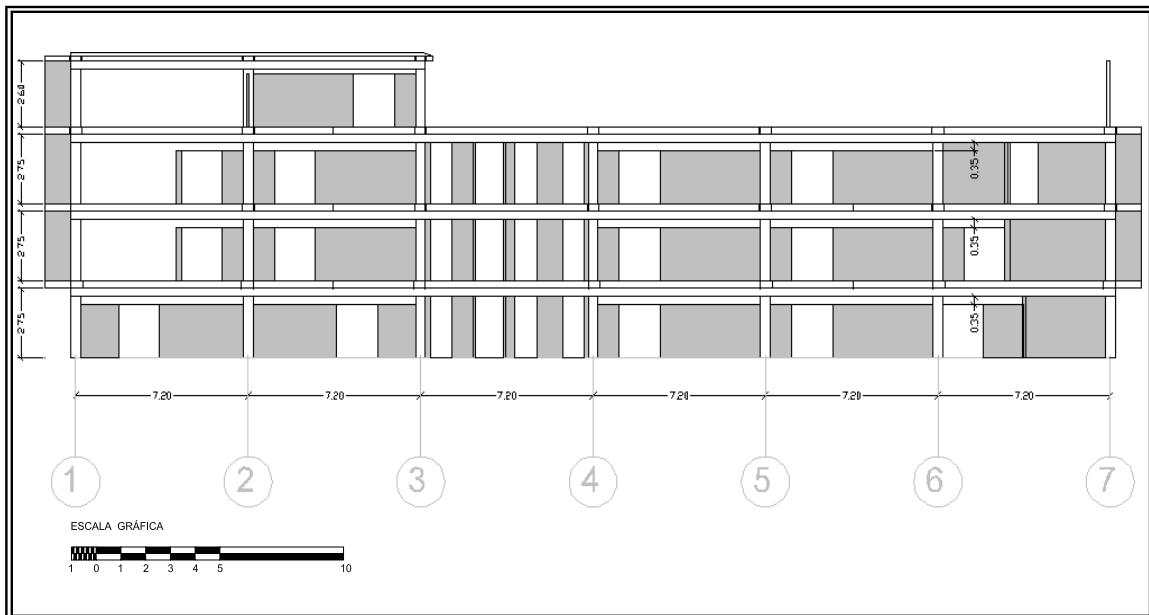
Pórtico 2 (norte-sur) mostrando las paredes de mampostería y la longitud efectiva de columnas
